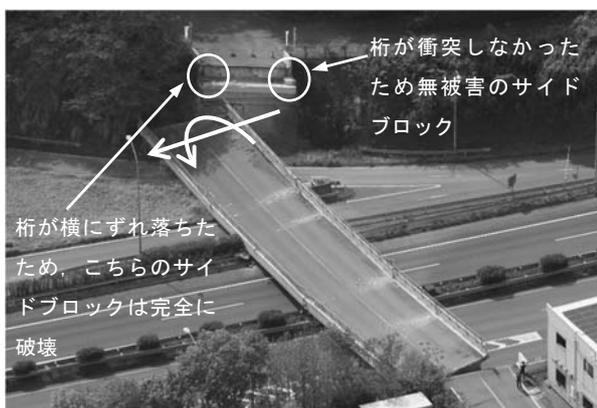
地震直後の府領第一跨道橋落橋状況（国土交通省HP掲載写真⁵⁾に加筆）
